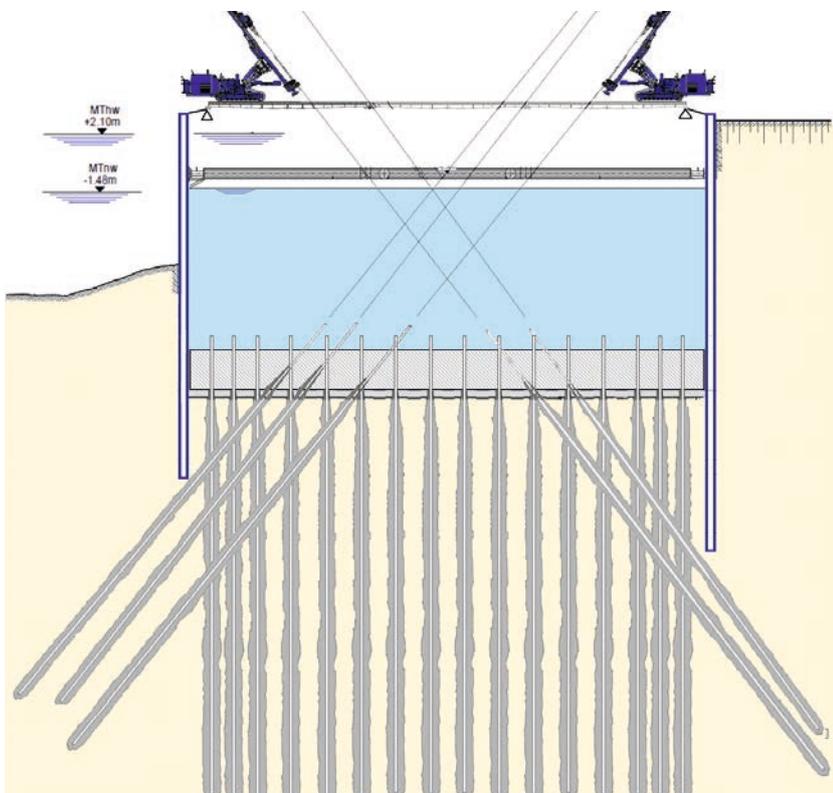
Schrägpfahlbohrungen im engen Bohrraster
